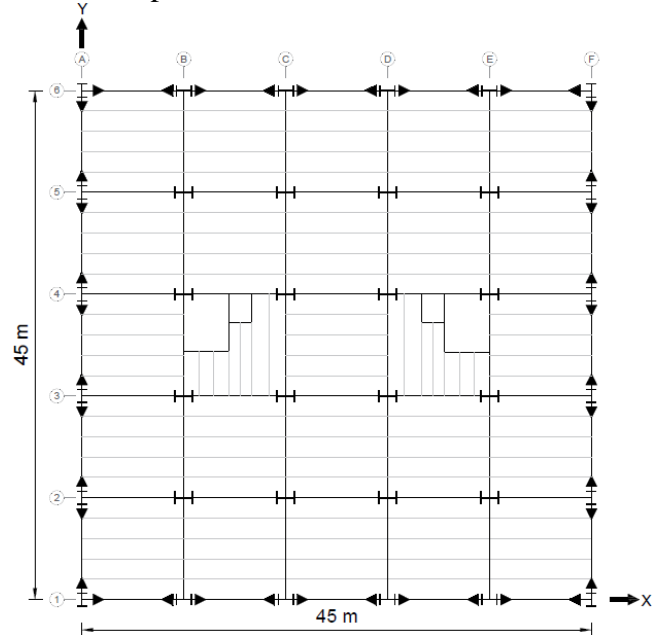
Planta de edificaciones analizadas (Estructura Tipo 2). [8]
